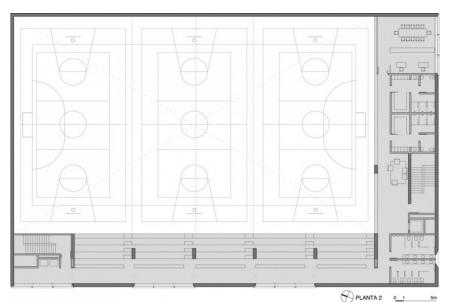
Planta arquitectónica alta. Fuente: http://www.archdaily.mx/70802/
